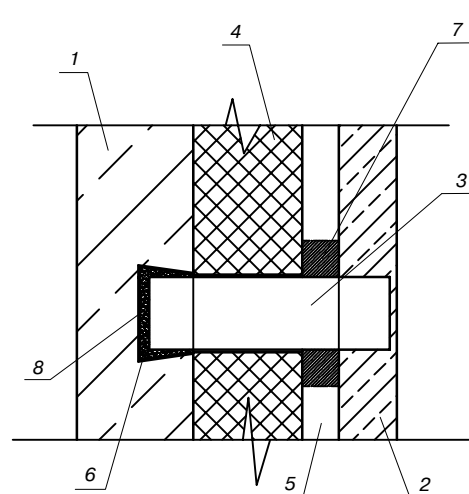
Фрагмент расположения консольной связи в панели: 1 – внутренний слой; 2 – элементы наружного слоя; 3 – консольная связь; 4 – утеплитель; 5 – вентиляционный зазор; 6 – пластиковый пустообразователь; 7 – фиксирующий состав; 8 – утеплитель
